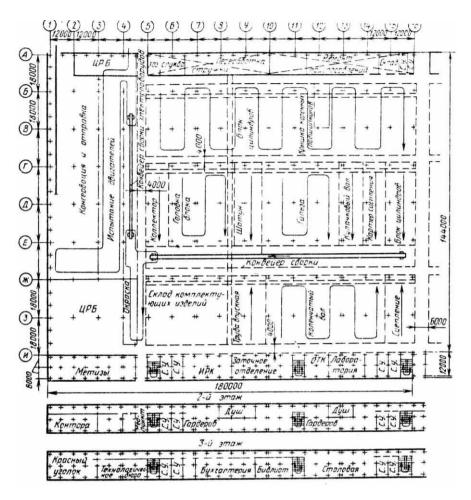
Компоновочный план корпуса по производству автомобильных двигателей
